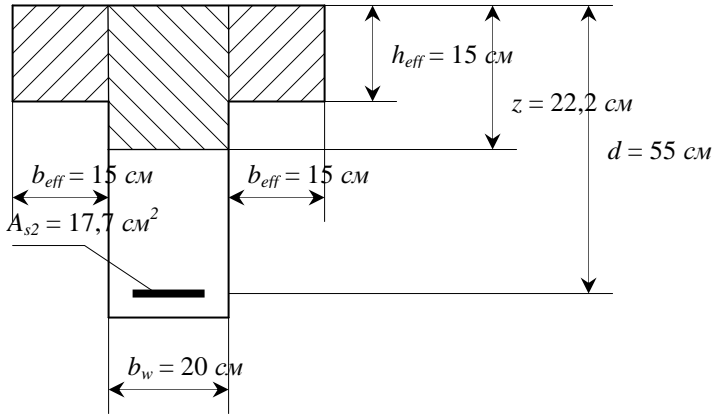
Схема поперечного перерізу елемента при положенні нейтральної лінії
